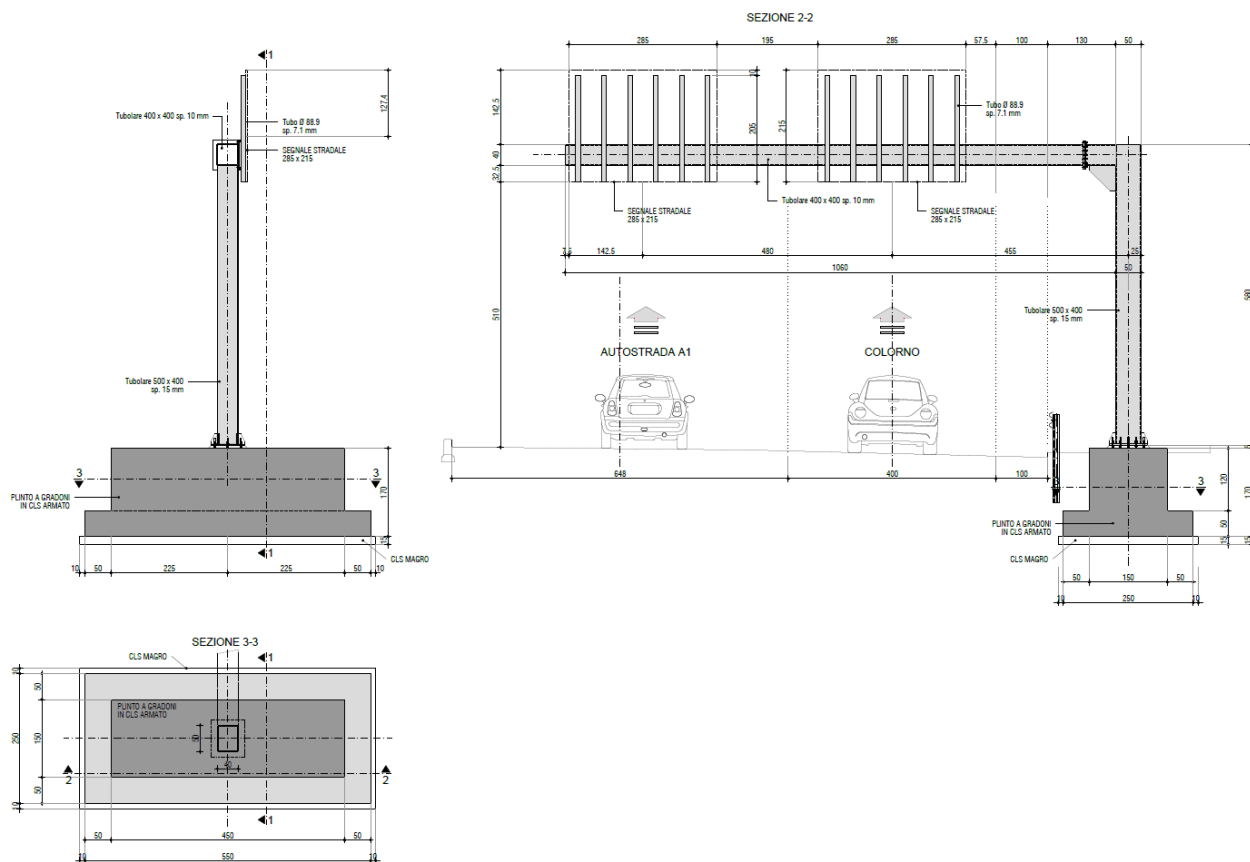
SEGNALE TIPO 2 – FONDAZIONI E ELEVAZIONI
